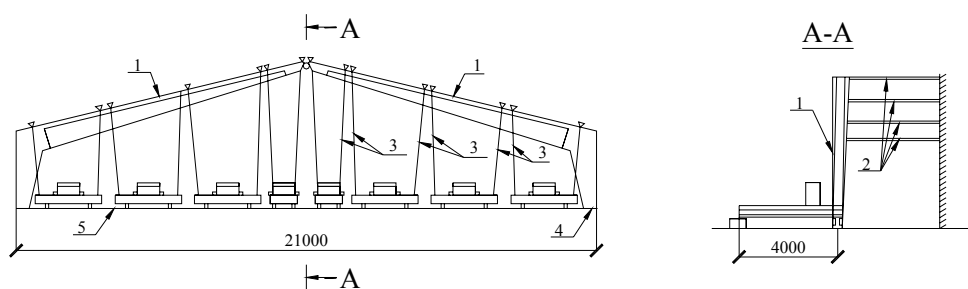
Схема стенда для испытаний рамных каркасов:
